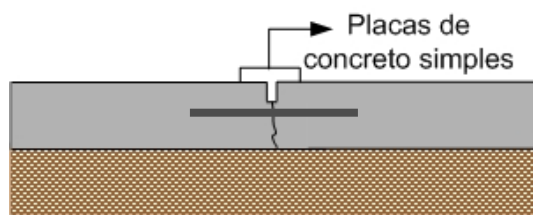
Perfil de um pavimento de concreto simples com barra de transferência.
